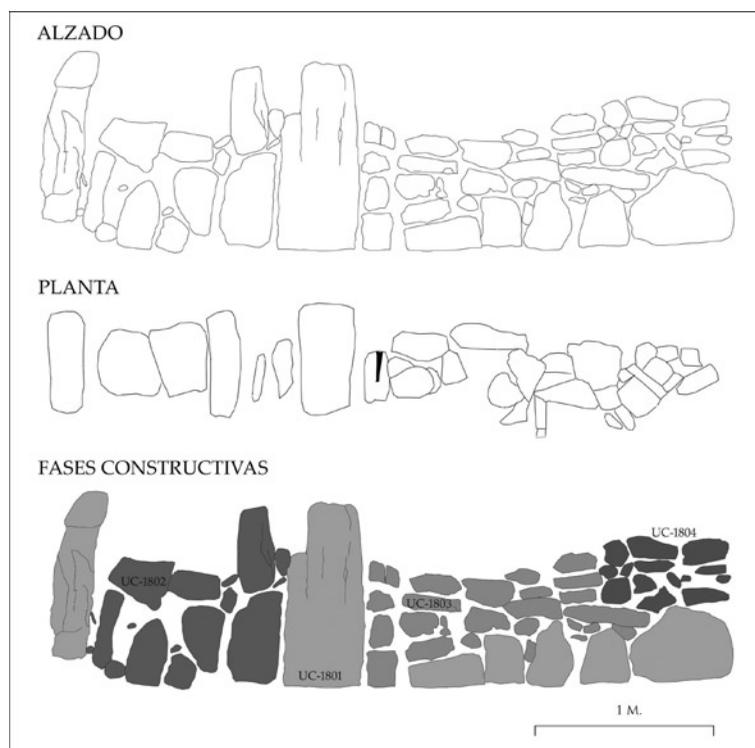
Alzado, planta y fases constructivas de G.U.C. 1800
